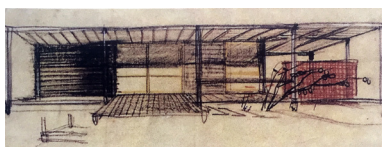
Croqui de estudo de Bratke para o pavilhão.
